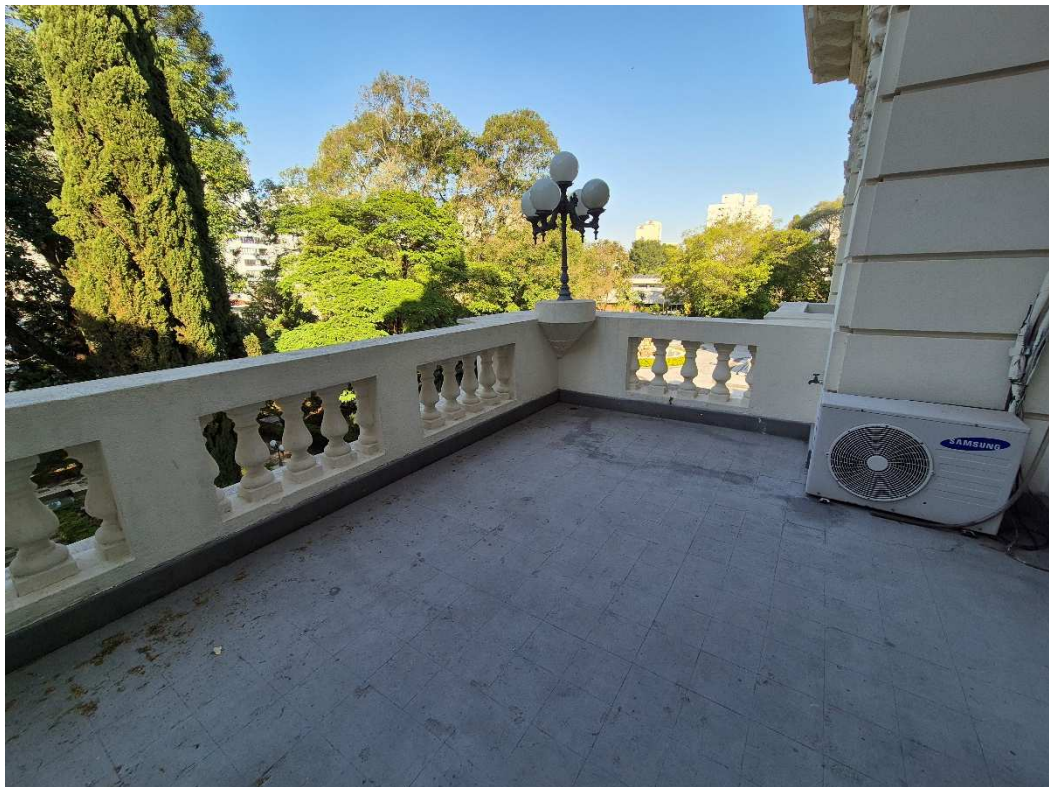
Aspecto interno da edificação principal (Pavimento Superior).
